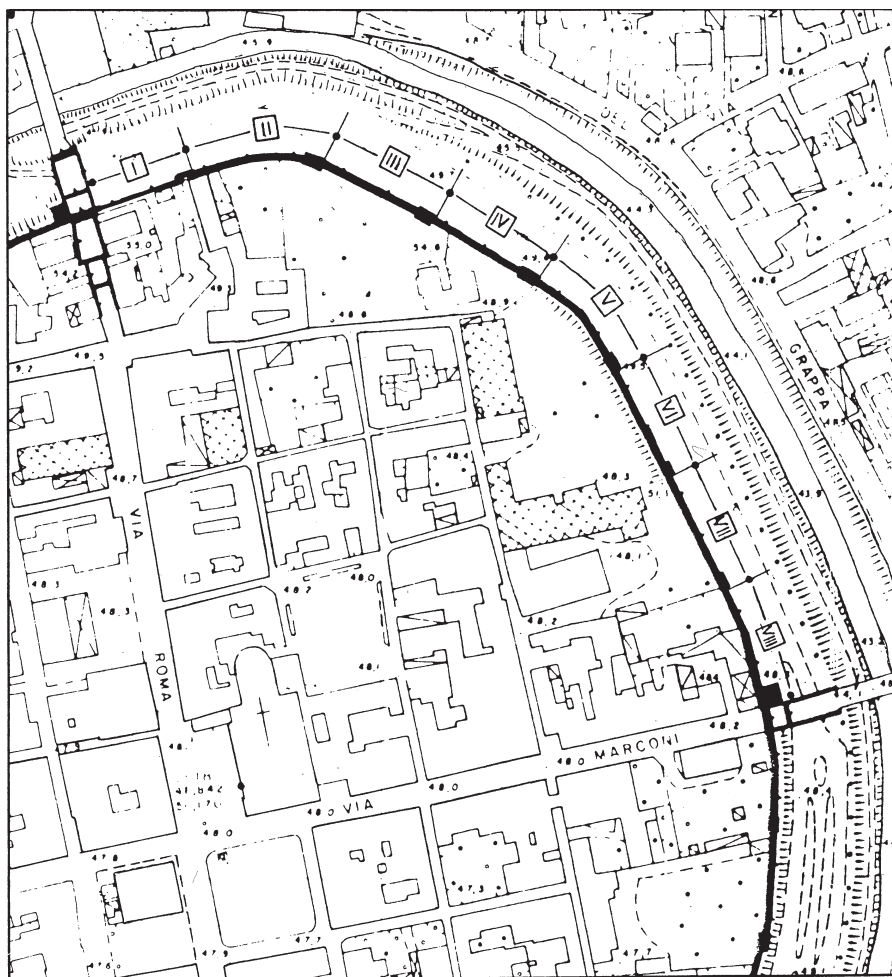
Particolare della planimetria di Cittadella (PD). Quadrante Nord-Est con la suddivisione in settori.
